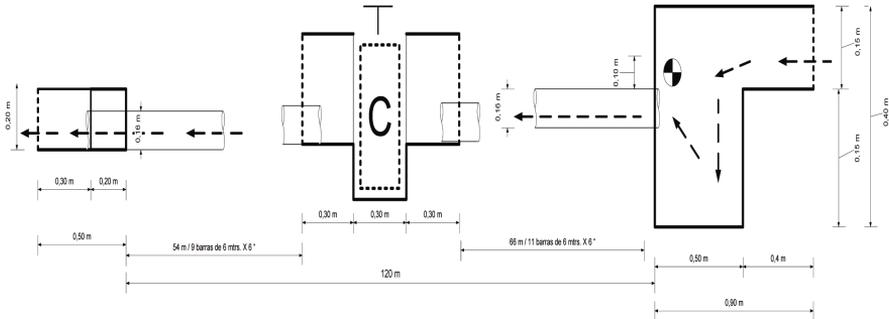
Corte longitudinal de la cámara de entrada del canal Camapo en Challasirca
